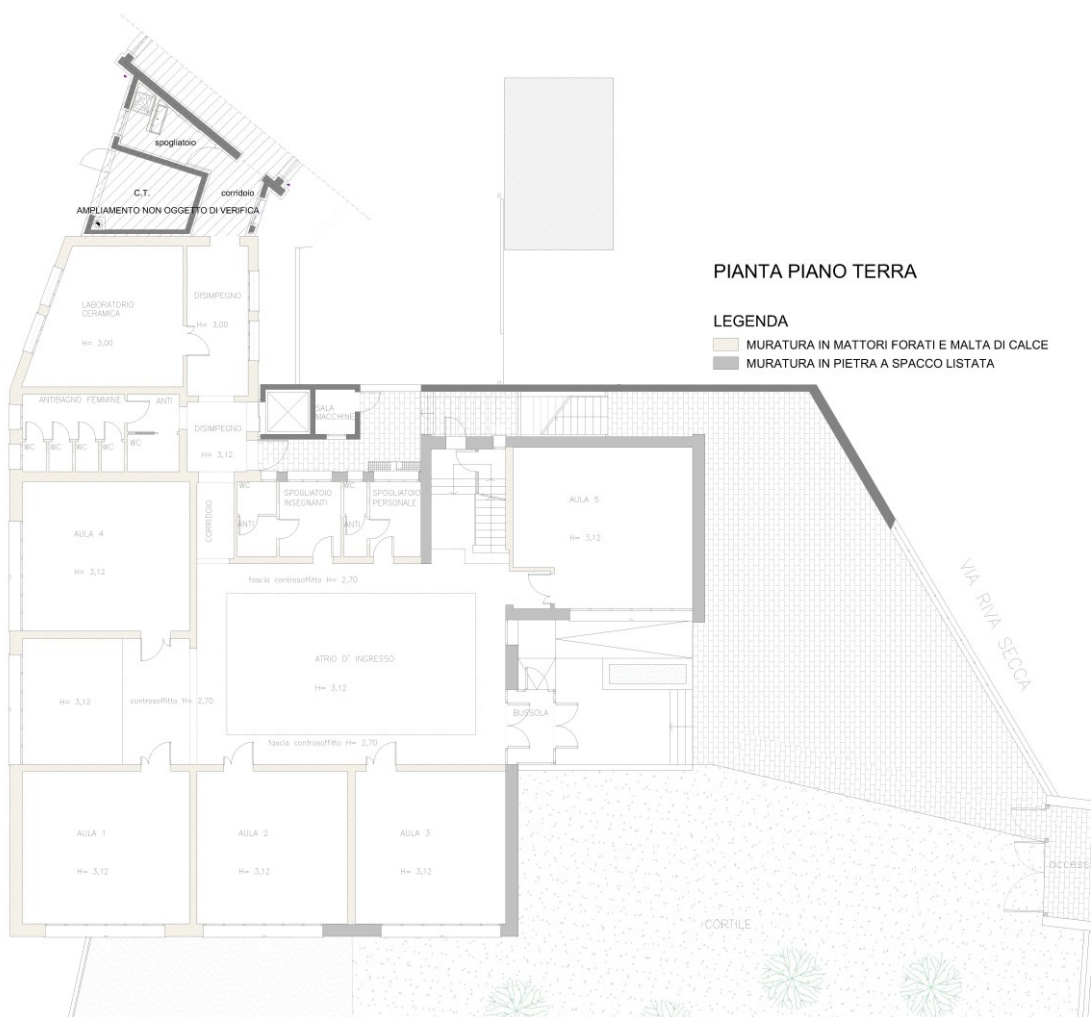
Pianta piano terra della Scuola Elementare di Segusino
